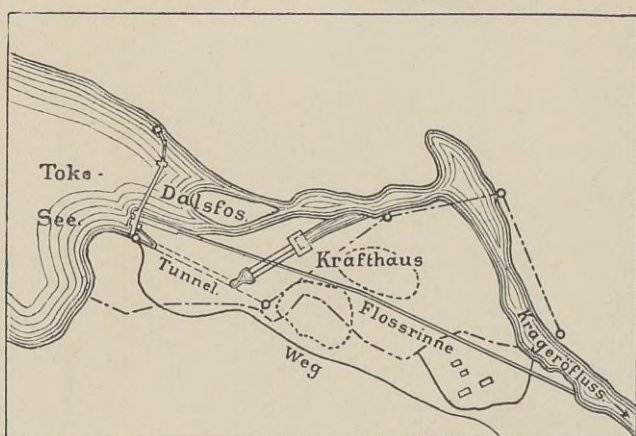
Dalsfos. Lageplan der Kraftanlage.
